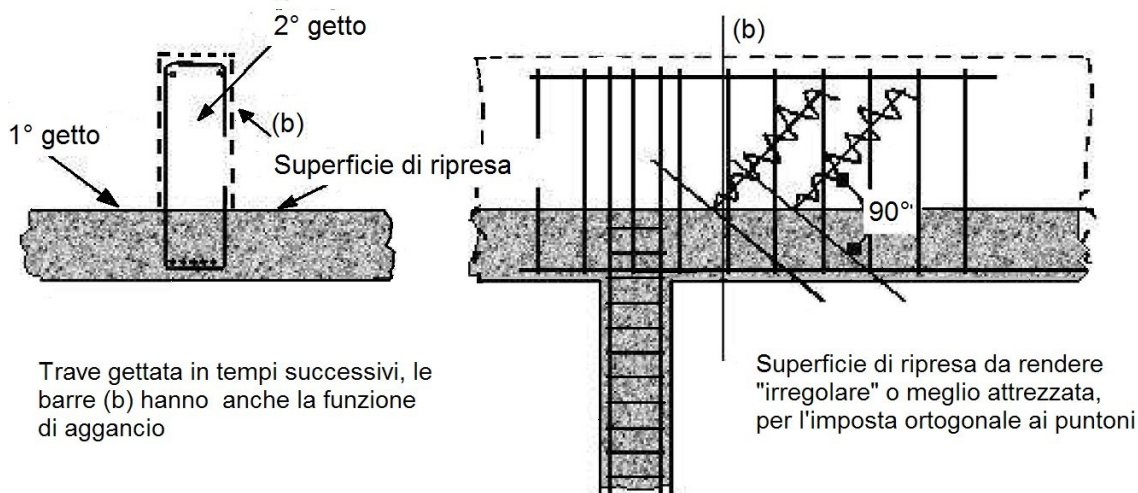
Modalità di ripresa del getto su travi di spessore elevato
